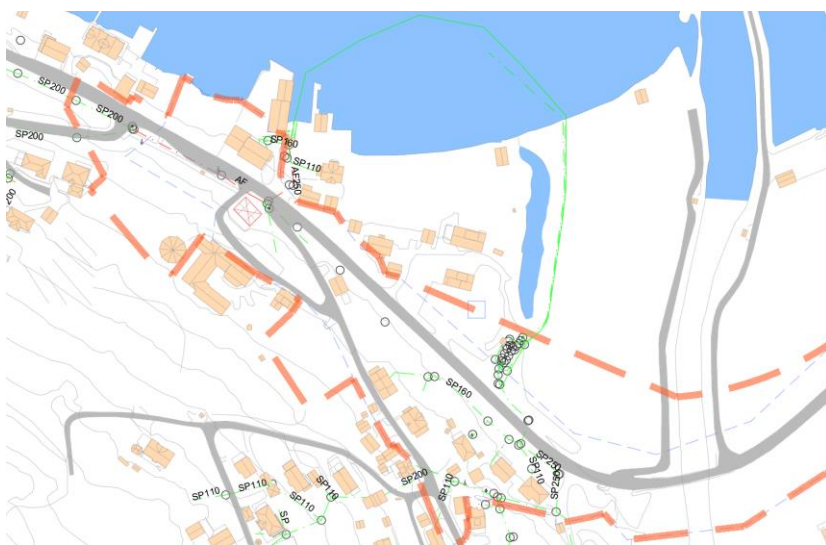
Eksisterande vassforsyning for planområdet. Planområdet er markert med raud stripe.
